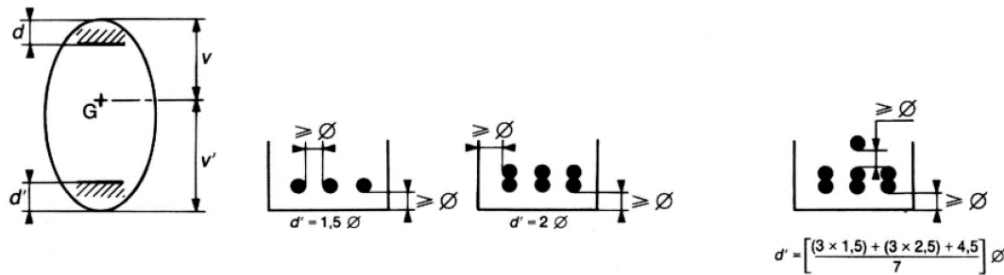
Dispositions constructives des câbles de précontrainte
